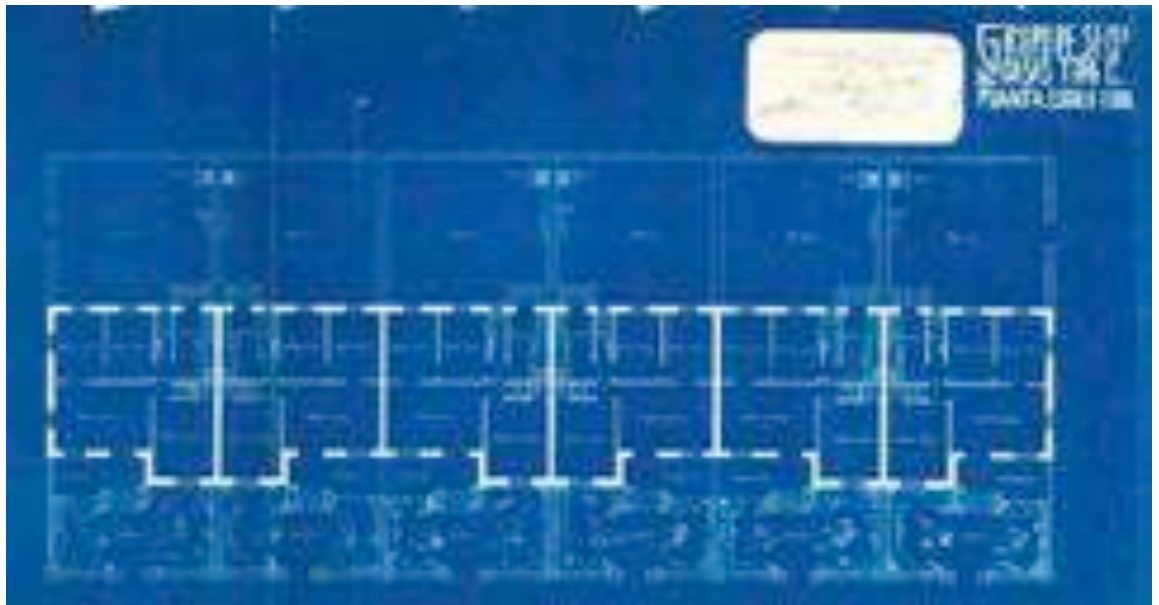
'Grupo de seis casas tipo 'C'. Plano de planta. V. Beltrí. 1927. ACMF CB 172/2.
